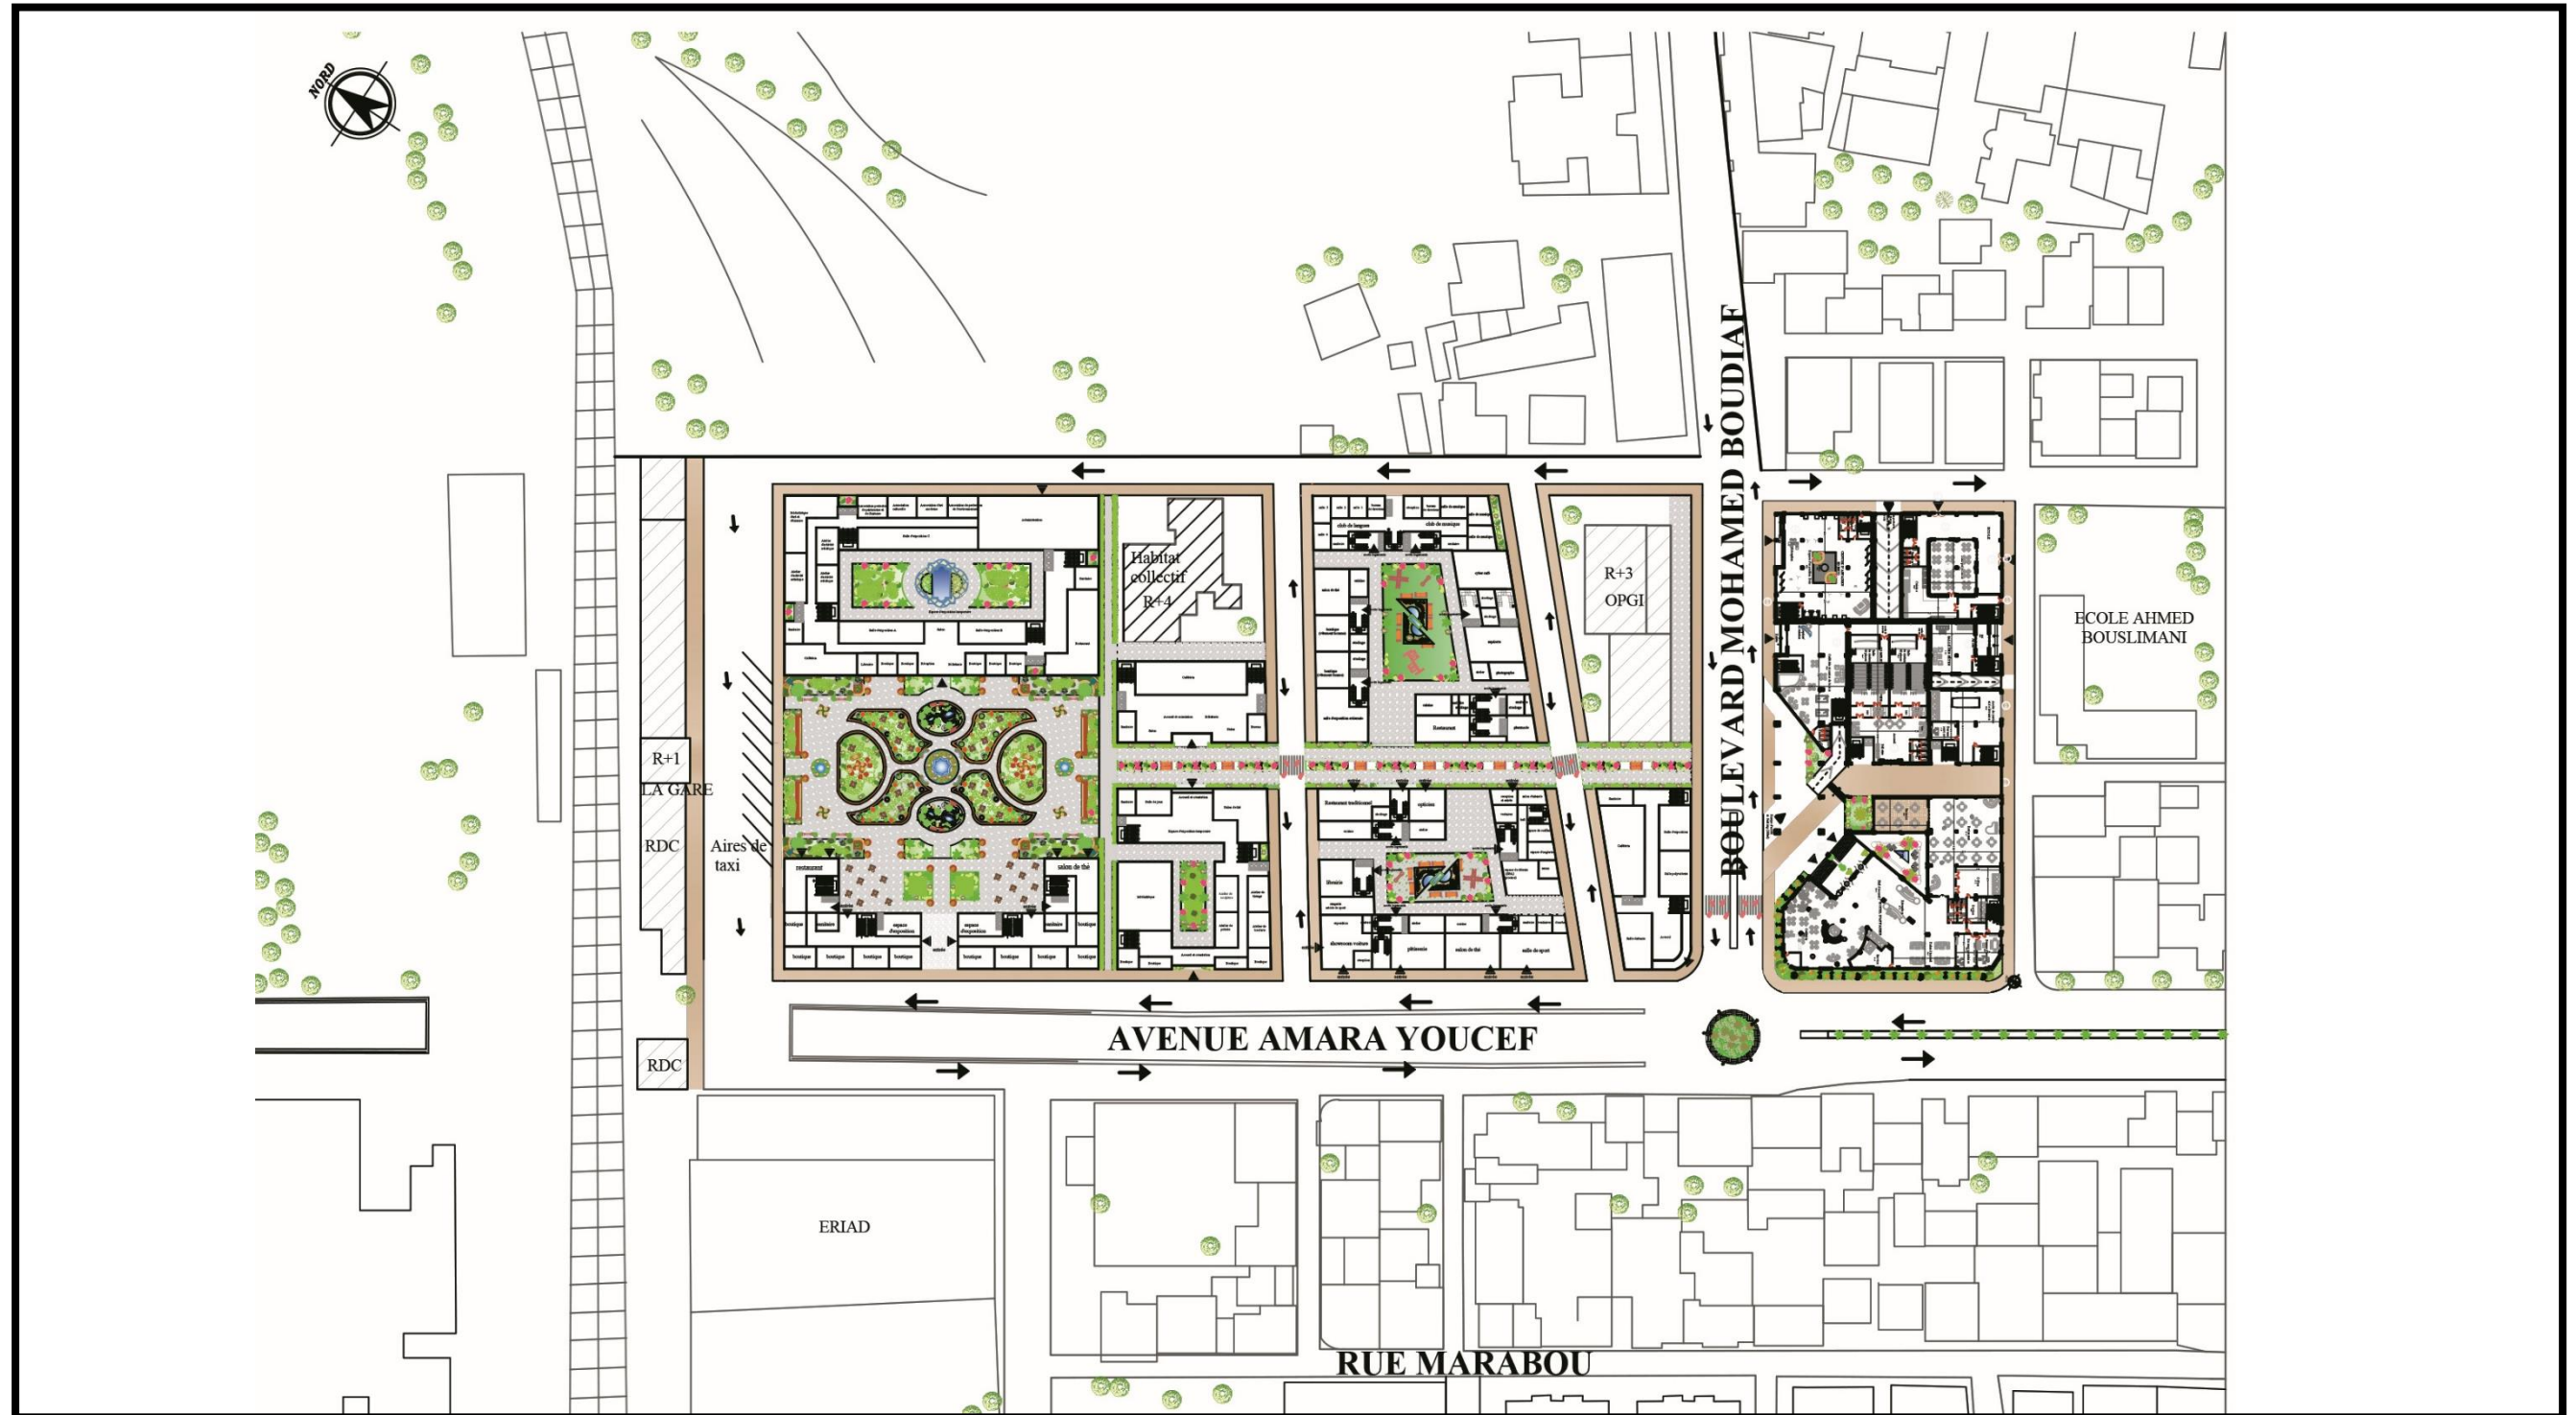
Plan de rez de chaussée de l'aire d'intervention.
